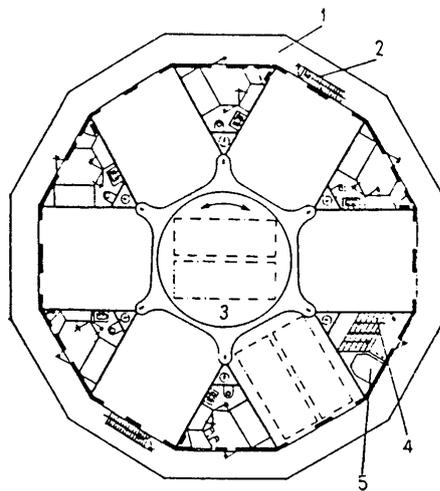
План башенного гаража с местами стоянок, расположенными радиально вокруг лифтовой шахты
